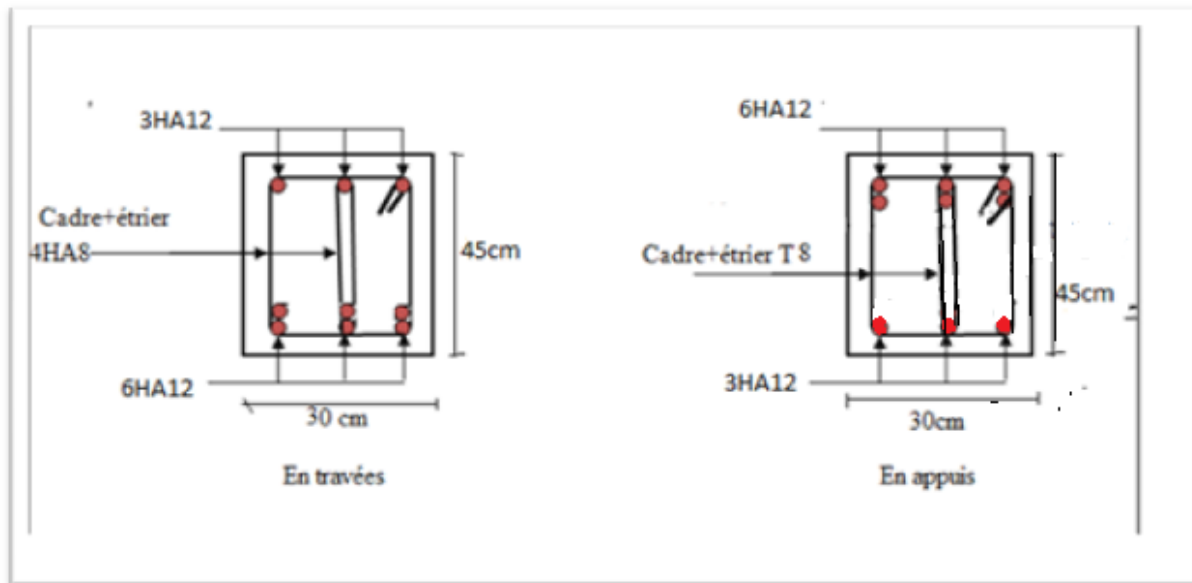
schéma de ferrailage poutres secondaires GRENIER
